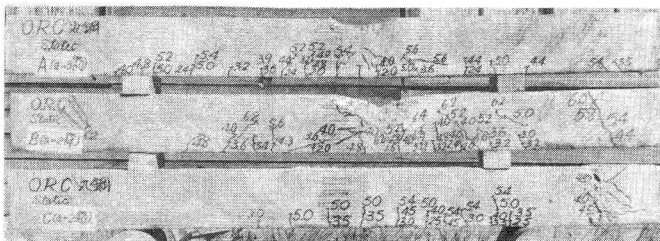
丸鋼過鉄筋ばりの荷重様相 A,B,C の場合のひびわれ
